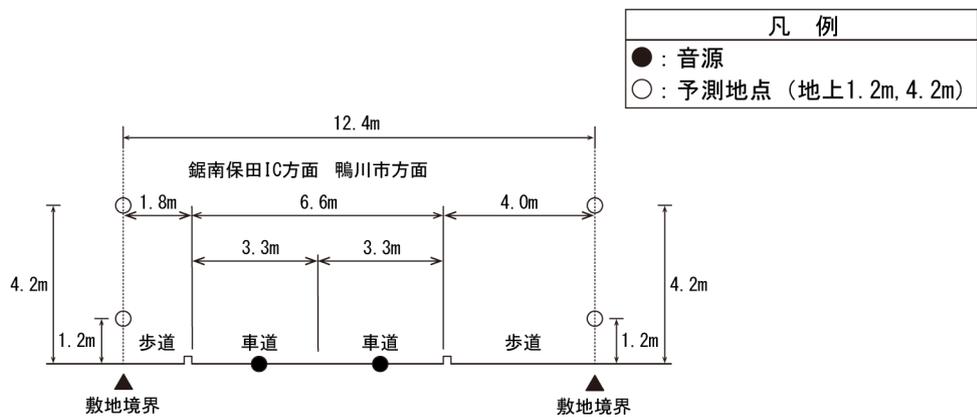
(4) 予測断面図 (D. 県道 34 号鴨川保田線)
